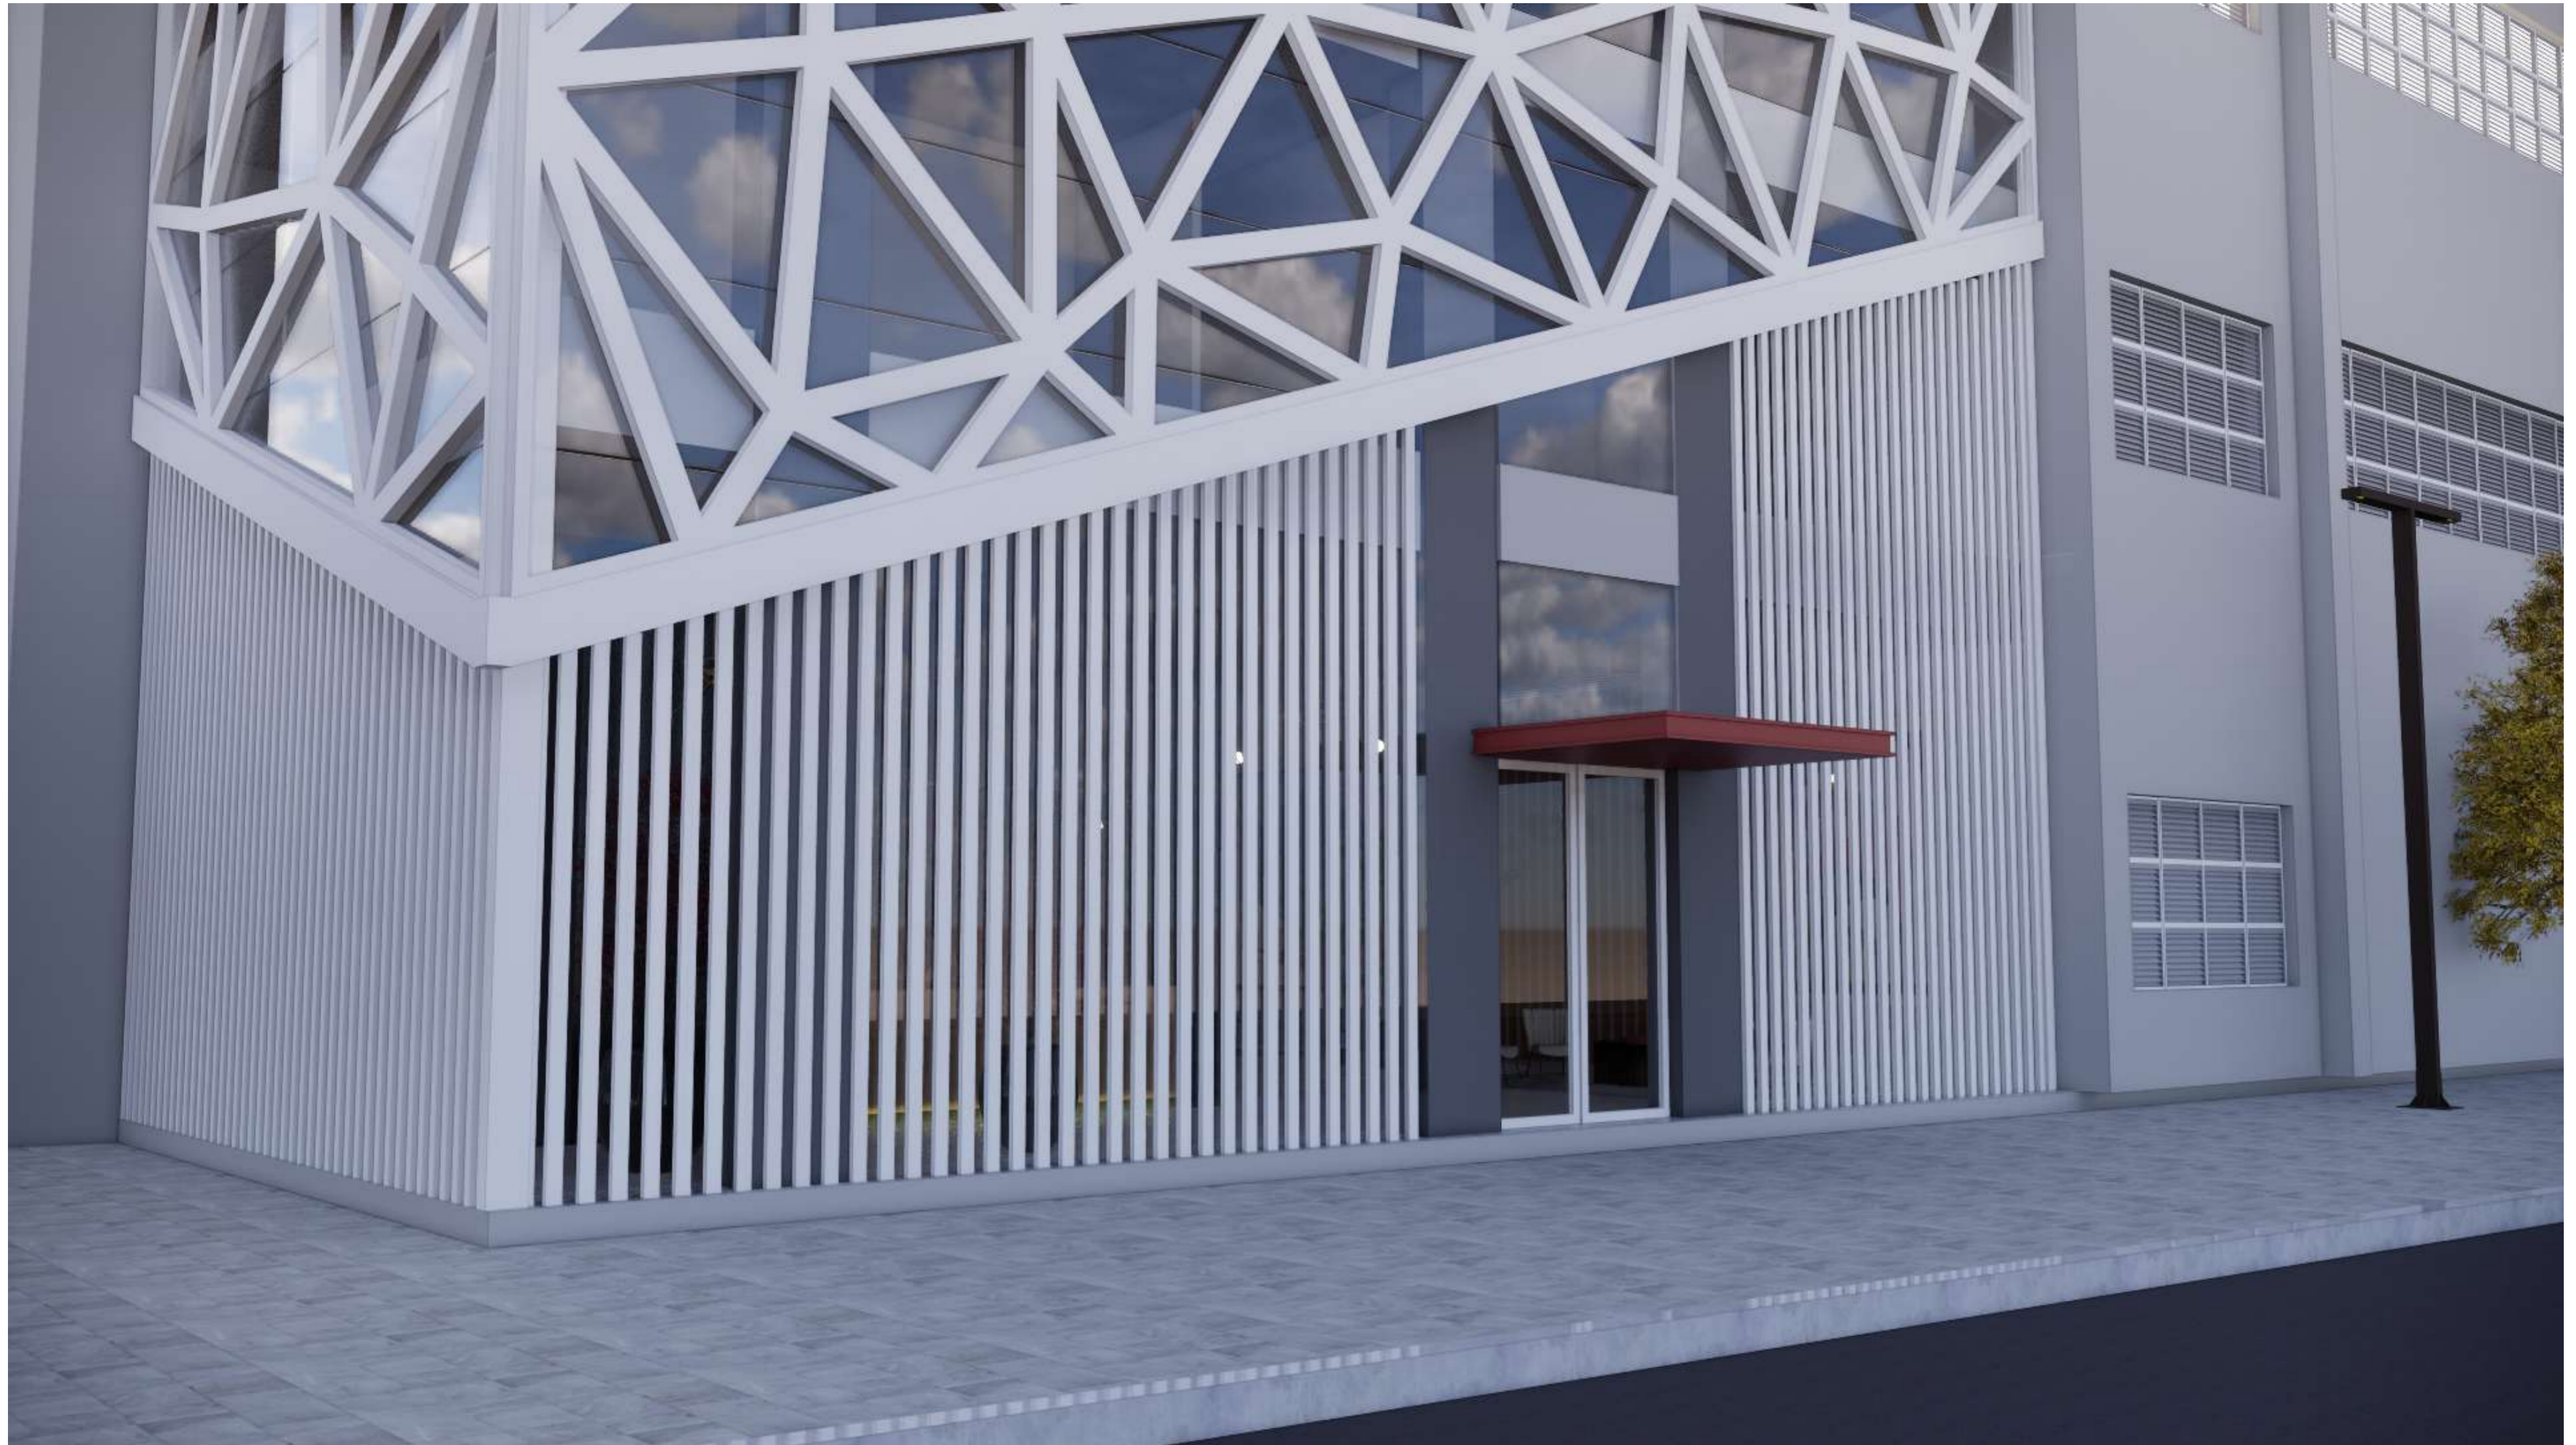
Ingreso fachada posterior. Elaboración Propia.
